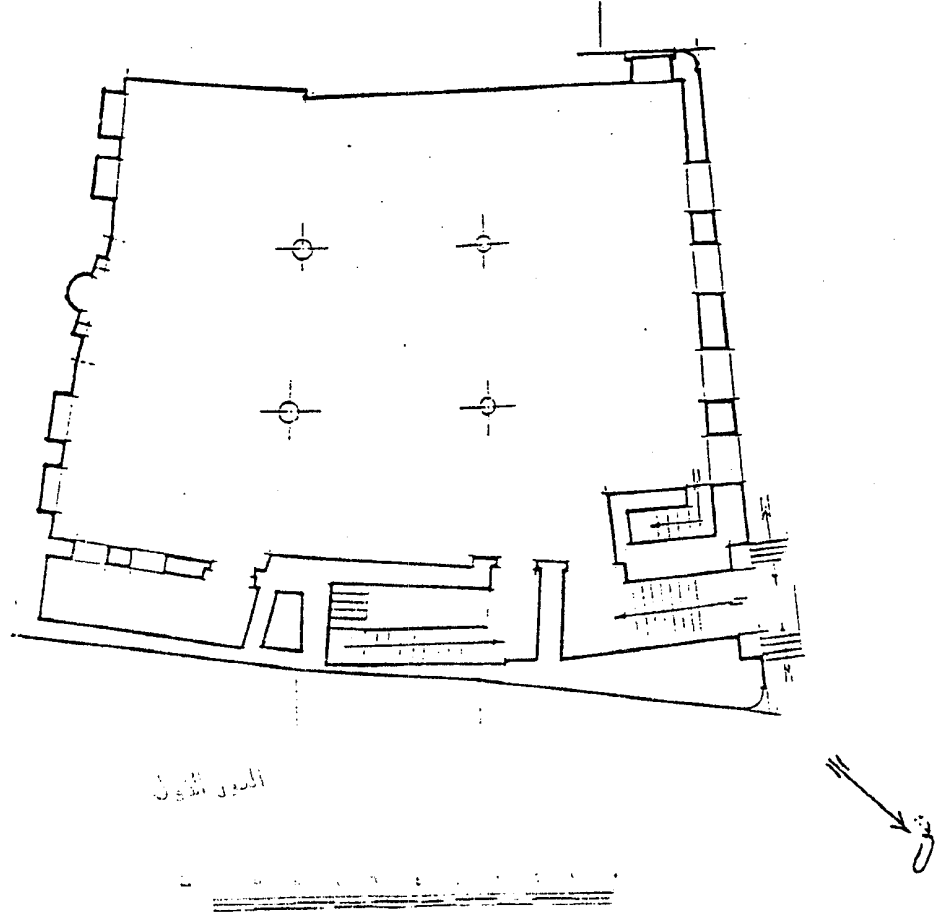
مسقط أفقي لخزانة سلاو سنجر الجاولي بالقاهرة
